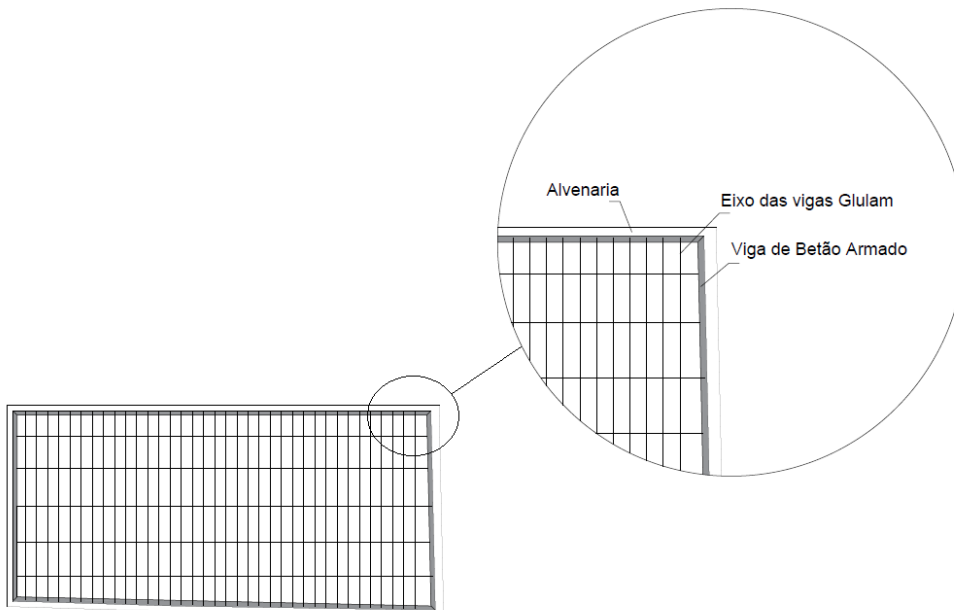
Pormenorização do coroamento através de uma viga de betão armado
